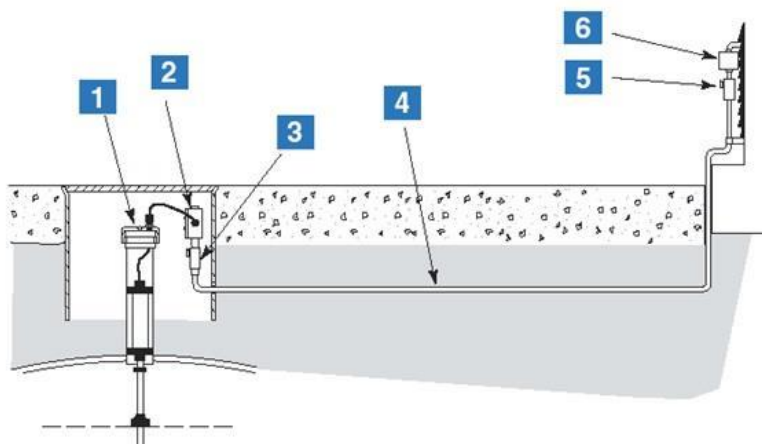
Пример прокладки кабеля зонда в жестком кабелепроводе, проходящем в грунте.
